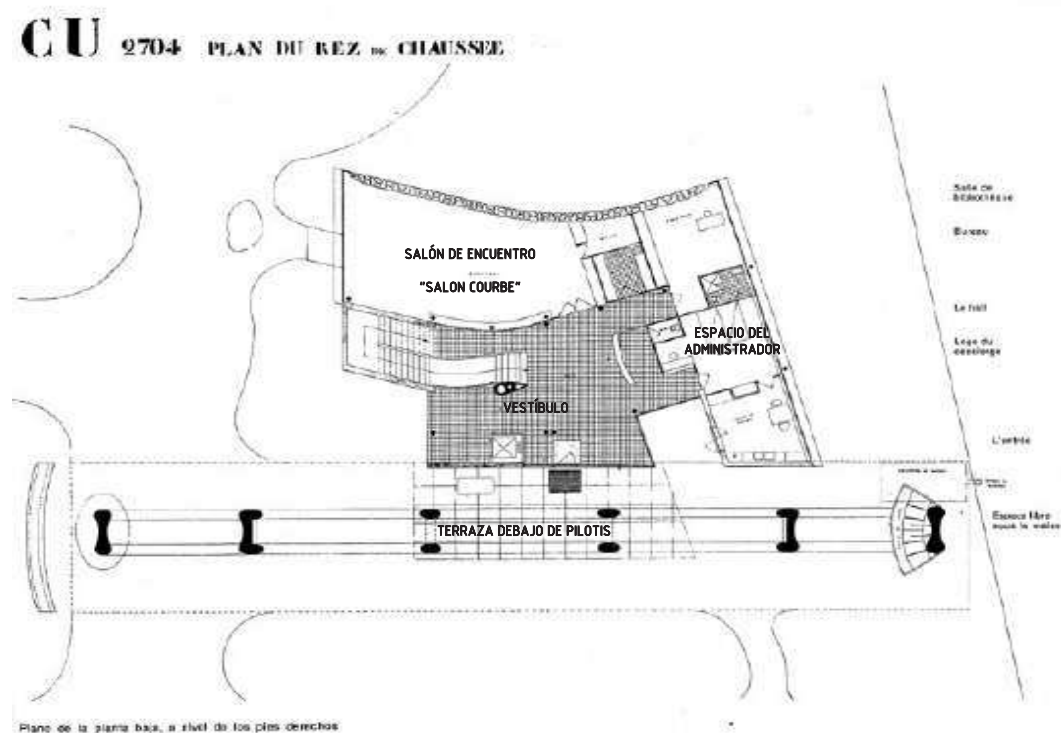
SE PUEDE OBSERVAR LA PLANTA BAJA DE LA EDIFICACIÓN
